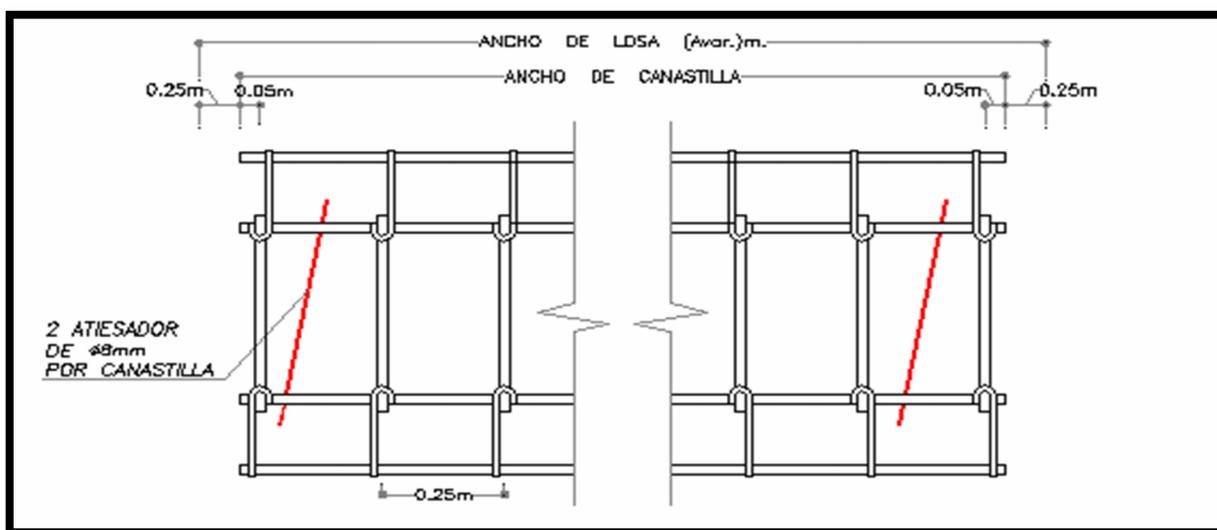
Detalle de la canasta pasajuntas en juntas transversales de construcción.
